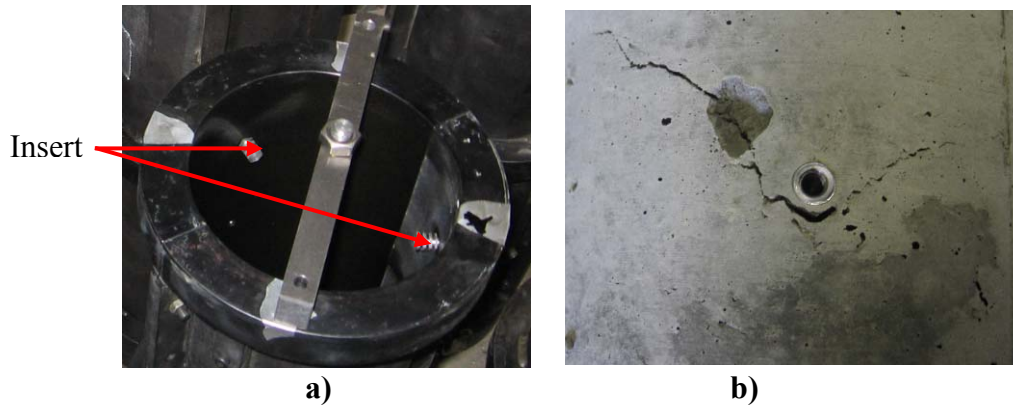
Inserts a) dans le moule, b) dans l'éprouvette.
